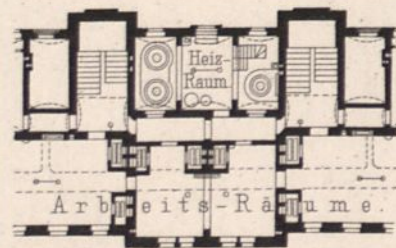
Krankenhaus B. Mitteltheil vom Grundriß des Kellergeschosses.
